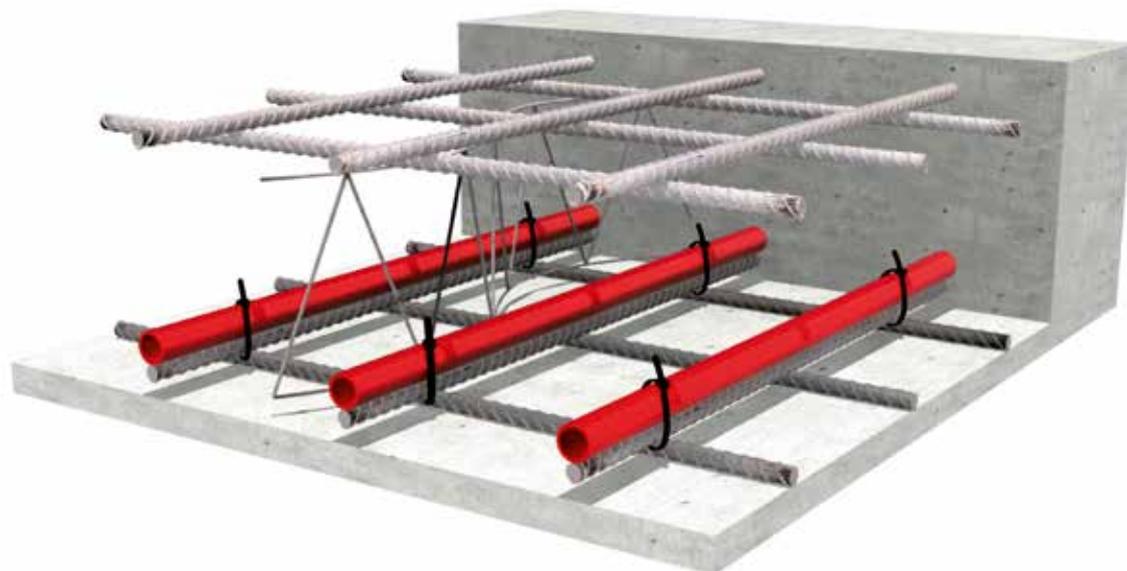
Schemaskizze des Aufbaus einer thermisch aktivierten Betondecke, © Z + B
